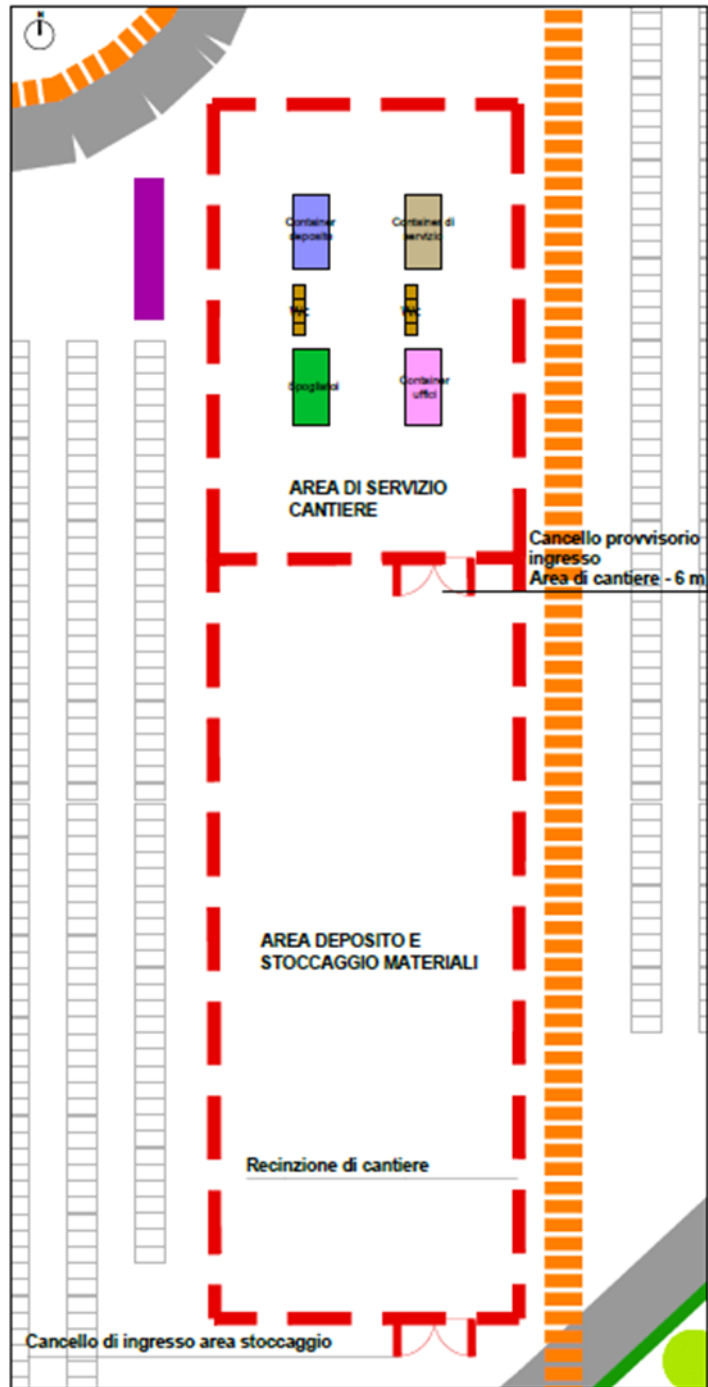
Aree di cantiere interne all'area di impianto con dettaglio dell'area di deposito e baracche di cantiere
